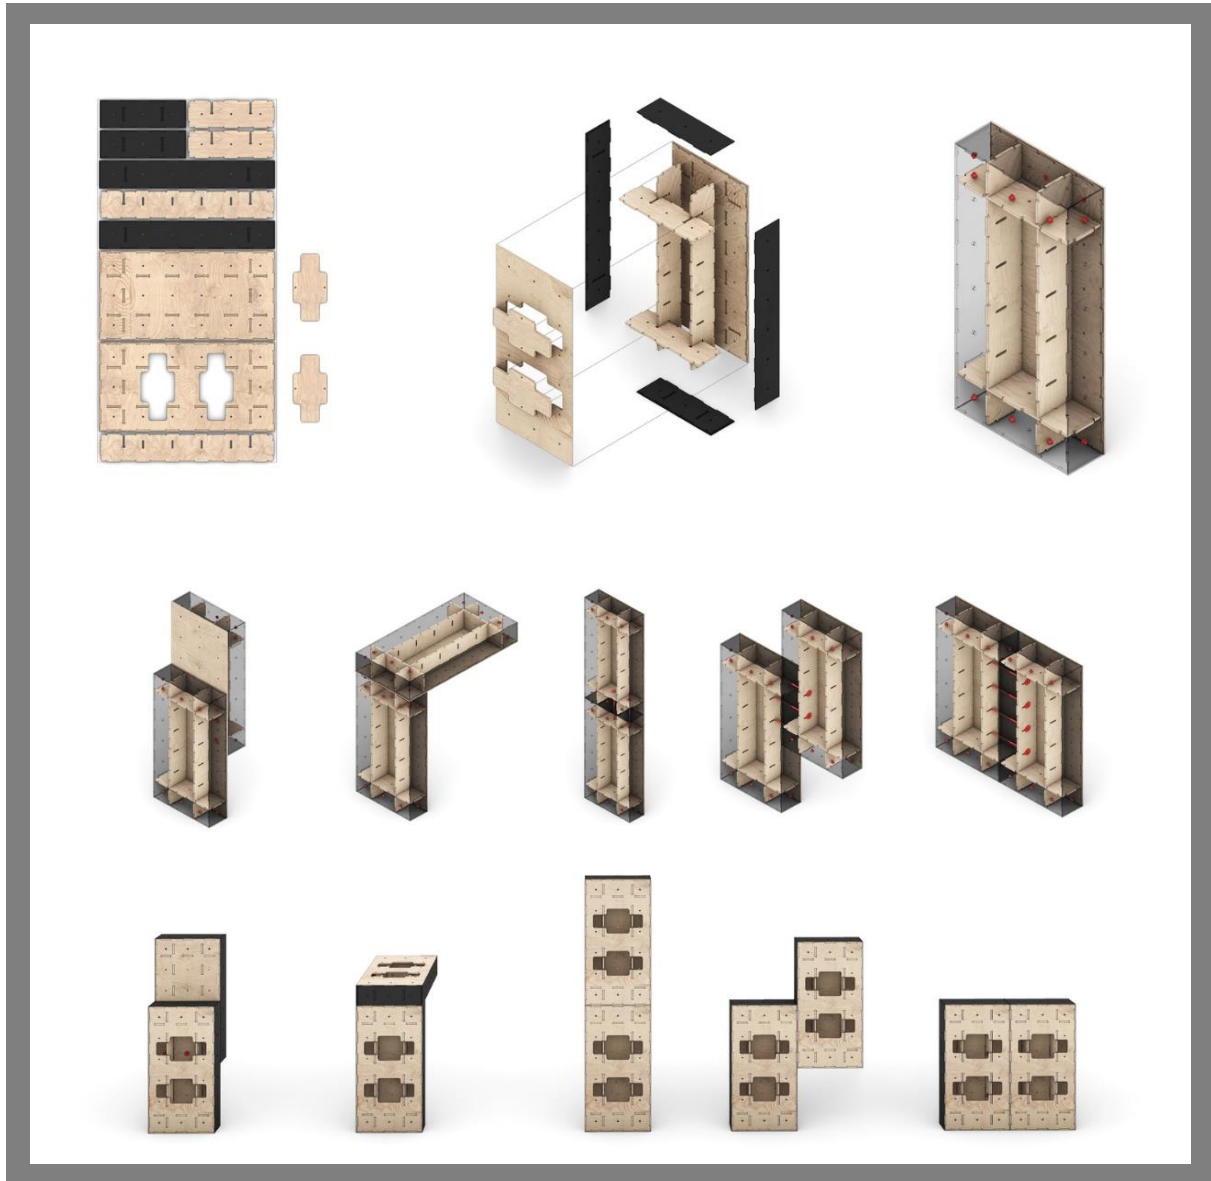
Se muestra desde la plantilla de corte en madera, hasta el ensamblado y desensamblado tanto vertical como horizontal. Fuente: Revista digital ArchDaily México. Accedido el 22 de enero 2022 en: <<https://www.archdaily.mx/mx/957825/pabellon-block-west-automated-architecture-auar-labs>>
